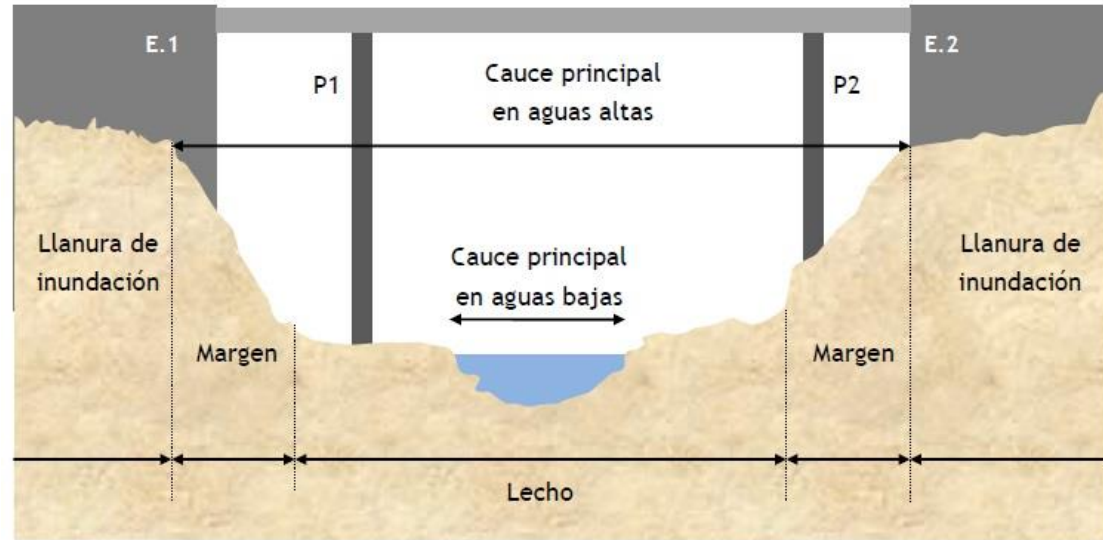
Zonas de inspección de cauce según una sección transversal (Fuente: Manual de Inspección Principal de Cauces)
